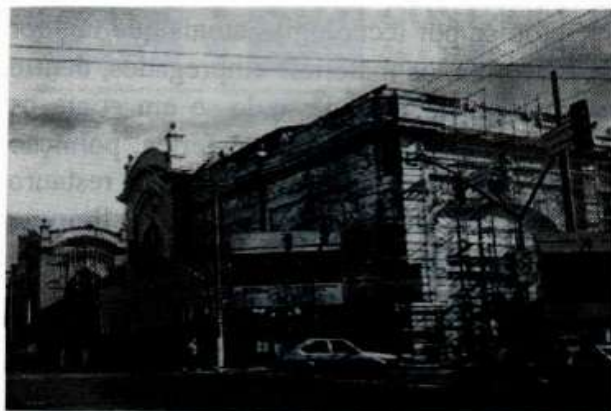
Vista parcial da fachada do Mercado situada à Av. Mercúrio.
